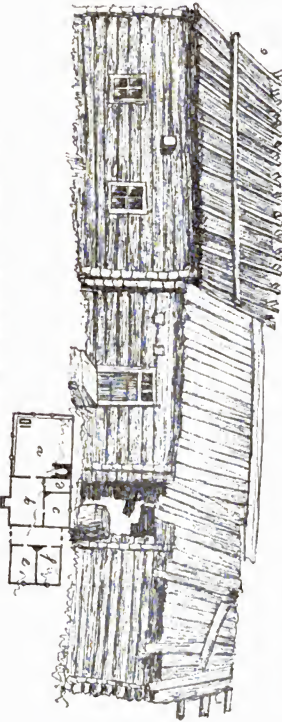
Grundriss eines karelischen Bauerhofes. Libelits. Kuopio.
